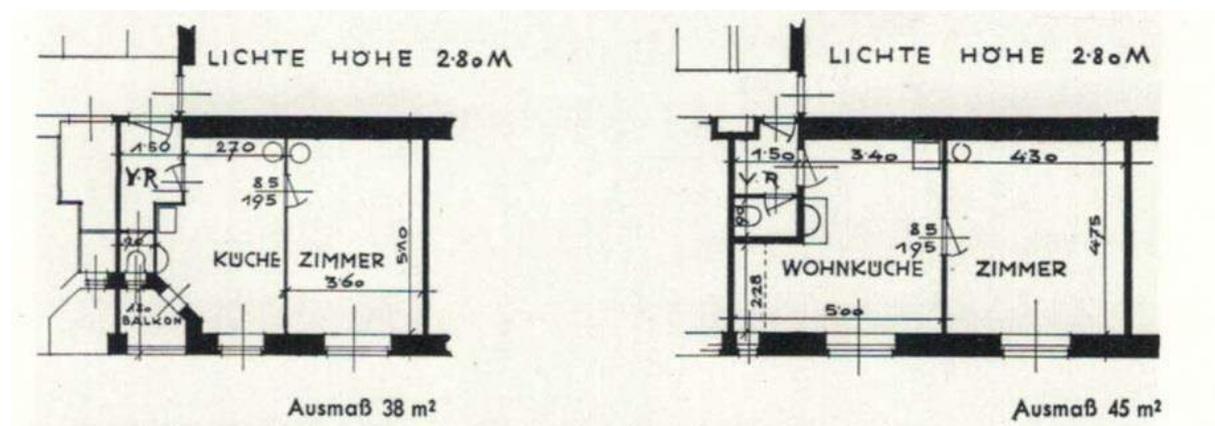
Grundrisstypen der Zwischenkriegszeit
